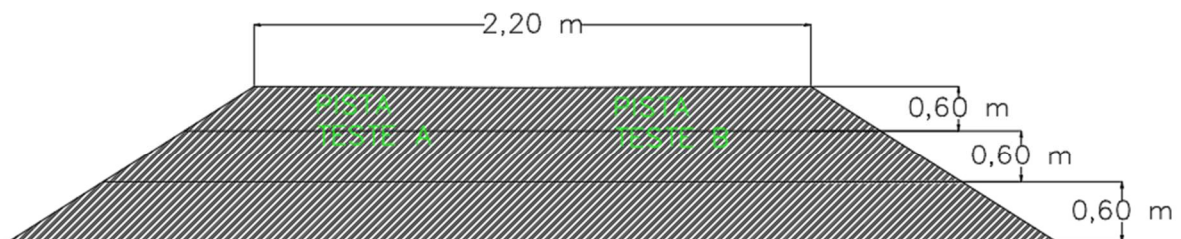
Croqui pista teste construída na pilha de rejeitos Cianita. Fonte : o autor
